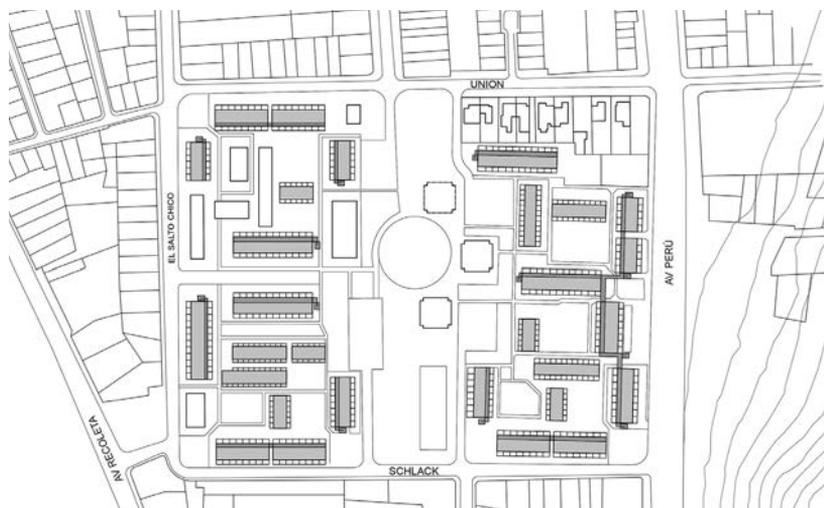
Túpac Amaru, Planimetría. Fuente: Elaboración propia.
